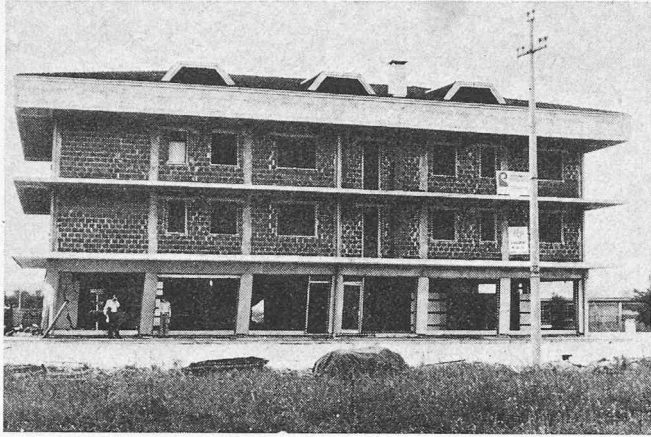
(nach dem 6. Mai). Links: Wohnhaus mit Verkaufslokal bei Artegna. Stahlbetonskelettbau mit Backsteinfüllwänden in den zwei Obergeschossen, im dreiseitig offenen Erdgeschoss sind nur die hintere Längswand und das Treppenhaus ausgefacht. Die Zerstörungen sind auf das Erdgeschoss konzentriert, in dem eine Drehbewegung um den Treppenhaukern mit rund 40 cm Maximalverschiebung auftrat. Die Backsteinwände des Treppenhauses wurden stark zerstört, diejenigen des Obergeschosses blieben unbeschädigt
